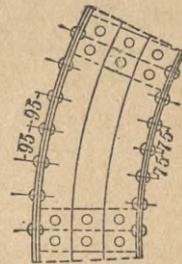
Eiserner Brunnenkranz mit Betonausfüllung.
